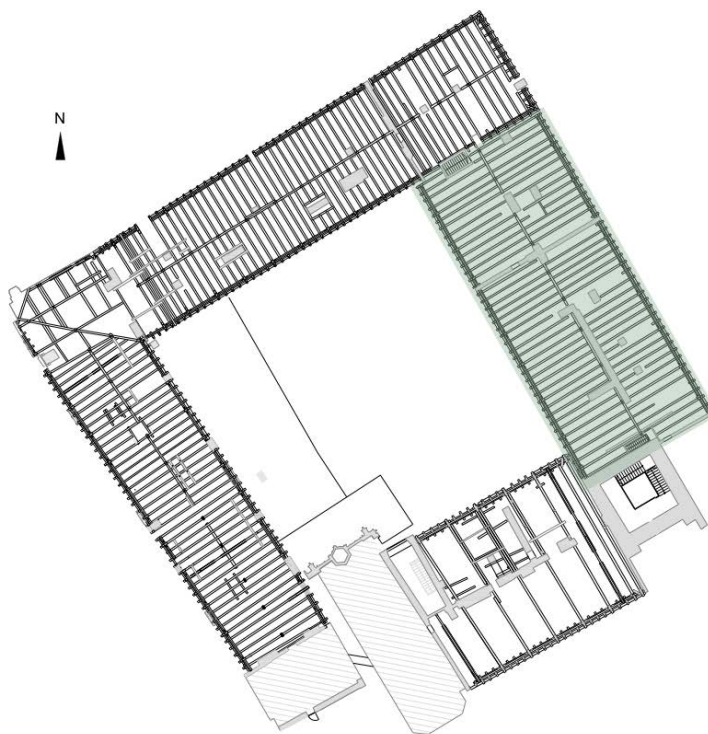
Lageplan Nordostdachwerk des Schweizerhofs mit Markierung des NO-Trakts
